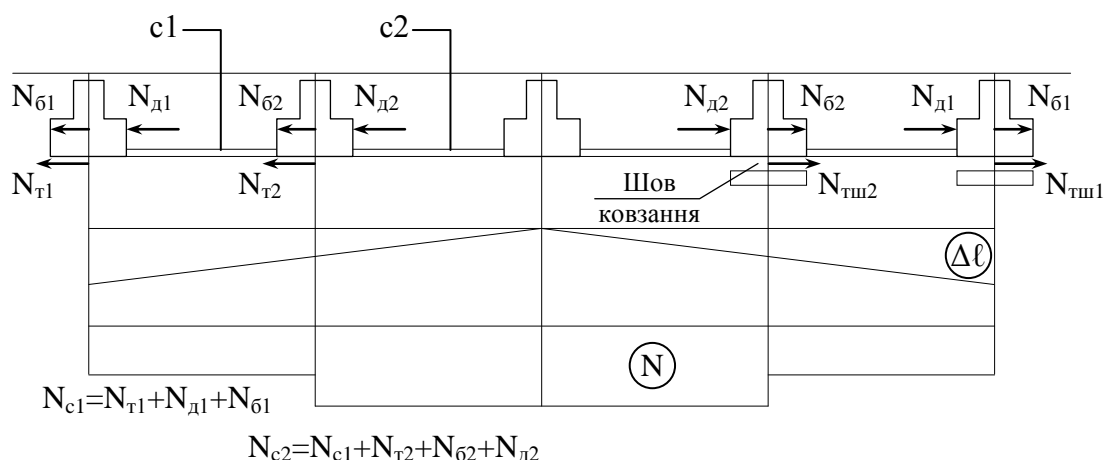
Принципова схема навантажень на фундаменти від горизонтальних деформацій земної поверхні ε : $\Delta\ell$ – графік горизонтальних переміщень основи; N – графік поздовжніх сил в фундаментних зв'язках-розпірках; $c1$, $c2$ – фундаментні зв'язки-розпірки; $N_{т1}$, $N_{д1}$, $N_{б1}$ – відповідно зрушуючі сили по підшві, нормальні тиски на лобові поверхні і зрушуючі сили по бічним поверхням фундаменту; N_{c1} – поздовжні сили в фундаментних зв'язках-розпірках
